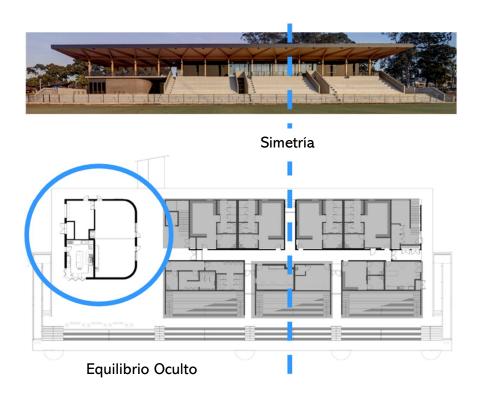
Elaboración propia Planta y fotografía de Fachada (Broardman 2021)⁵³
